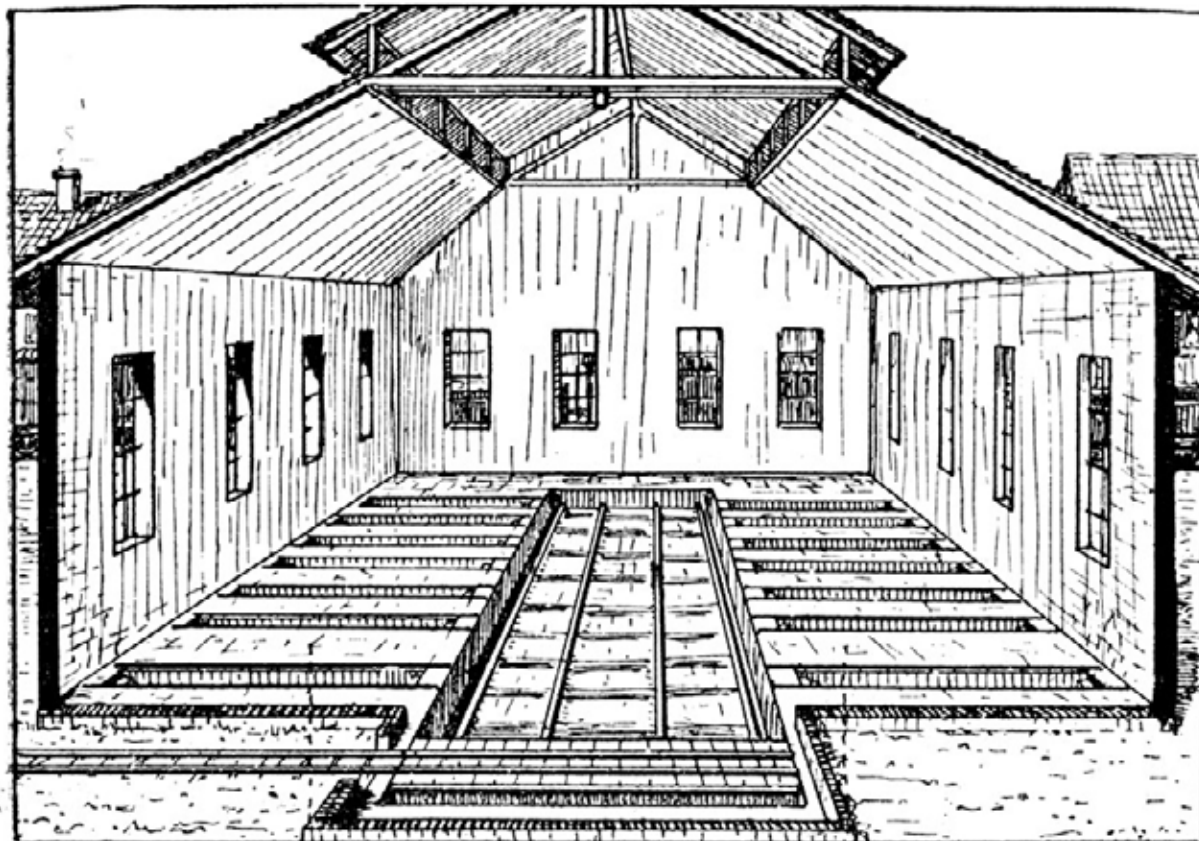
Небольшой прямоугольный паровозный сарай без передвижной тележки. Сарай показан схематически без одной стены.
